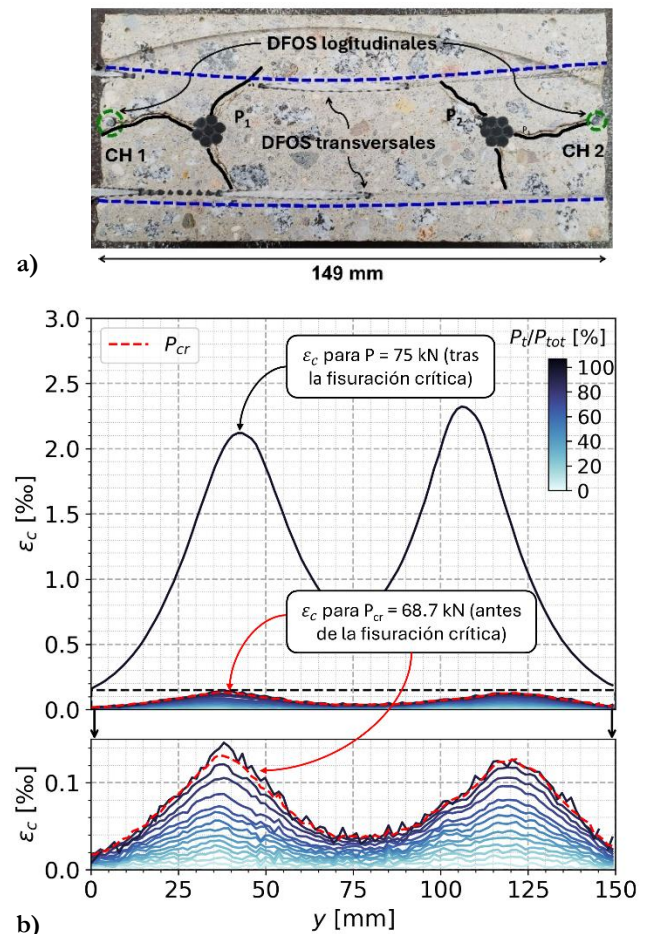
Ensayo DP a 50 mm del extremo de la viga: a) Sección fisurada tras el ensayo; b) Deformación transversal (ϵ_c) en función del pretensado transferido (f_{pt}).
